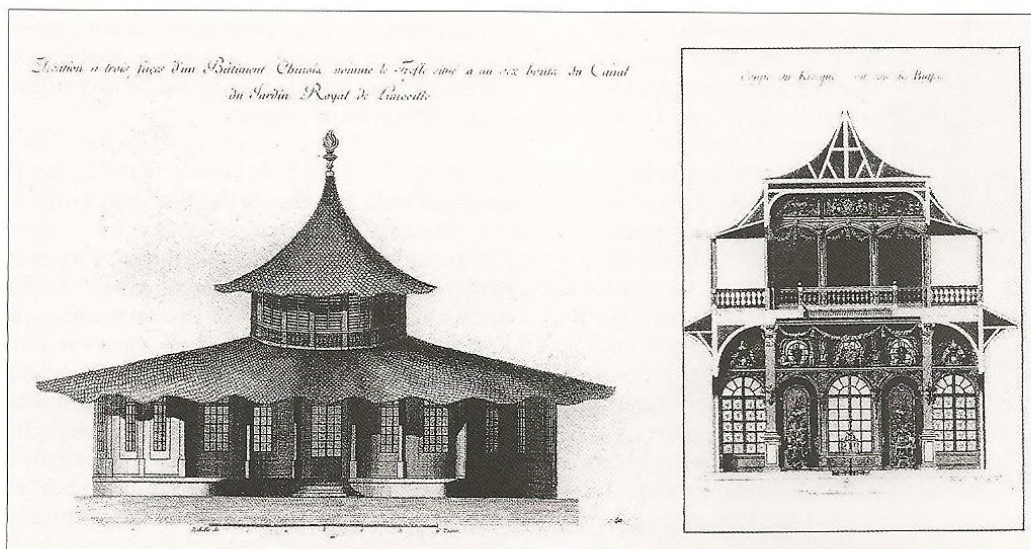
Emmanuel Héré, Coupe et élévation du Pavillon du Trèfle à Lunéville, 1742 (François Lotha, *Recueil des plans et élévations et coupes tant géométrales qu'en perspectives des châteaux, jardins [...]*, Paris, 1753).
